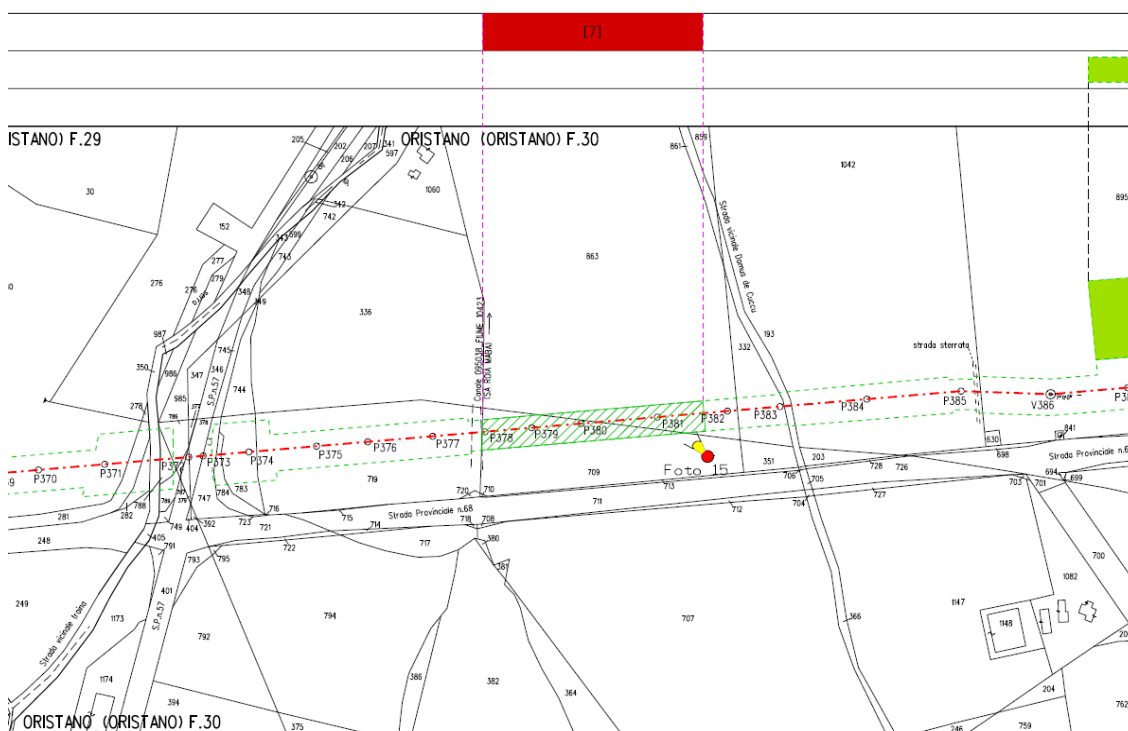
Tratto P378 - P381+30mt - la zona delimitata dalle linee verdi rappresenta la fascia ristretta di lavoro per come previsto dalla GASD C 13.40.10.02
